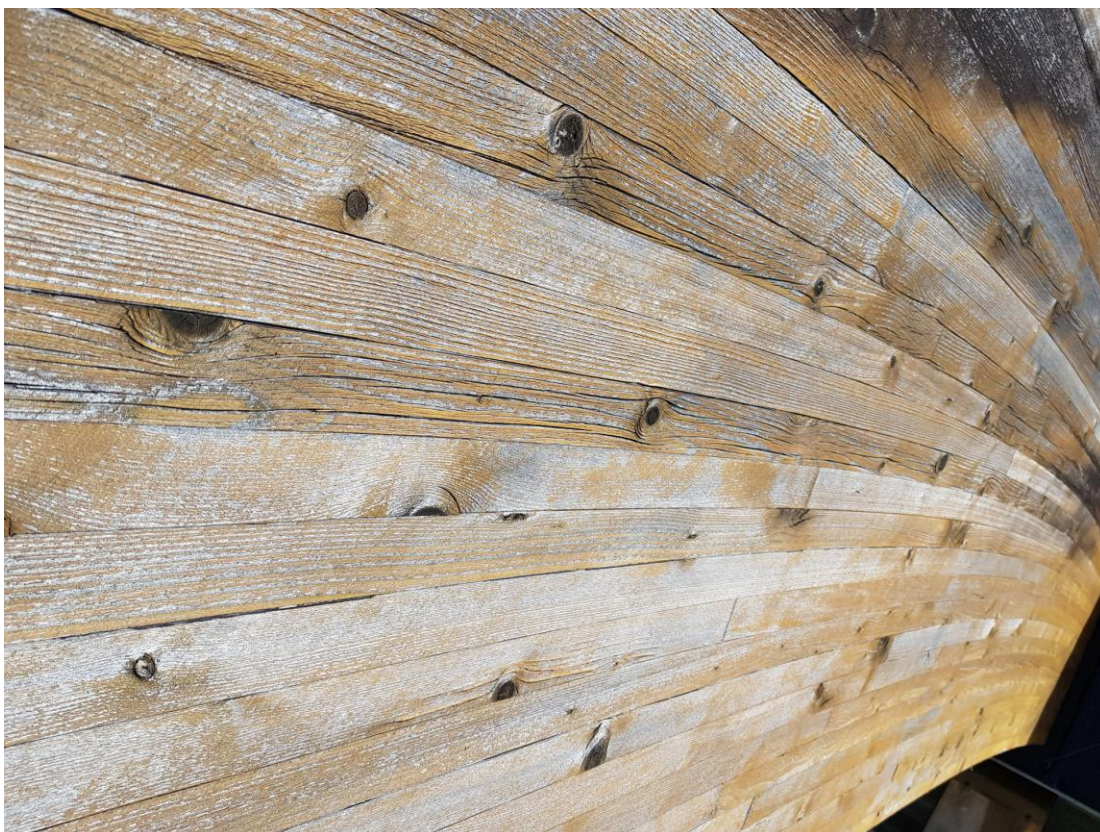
face da viga orientada a sudeste (onde é possível verificar a fissuração)
